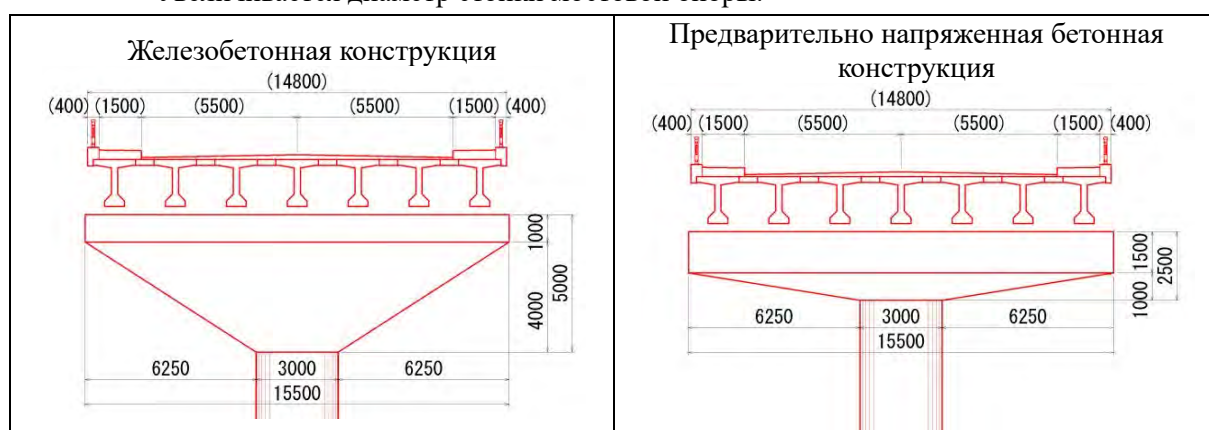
41 Тип конструкции опорной балки фермы
